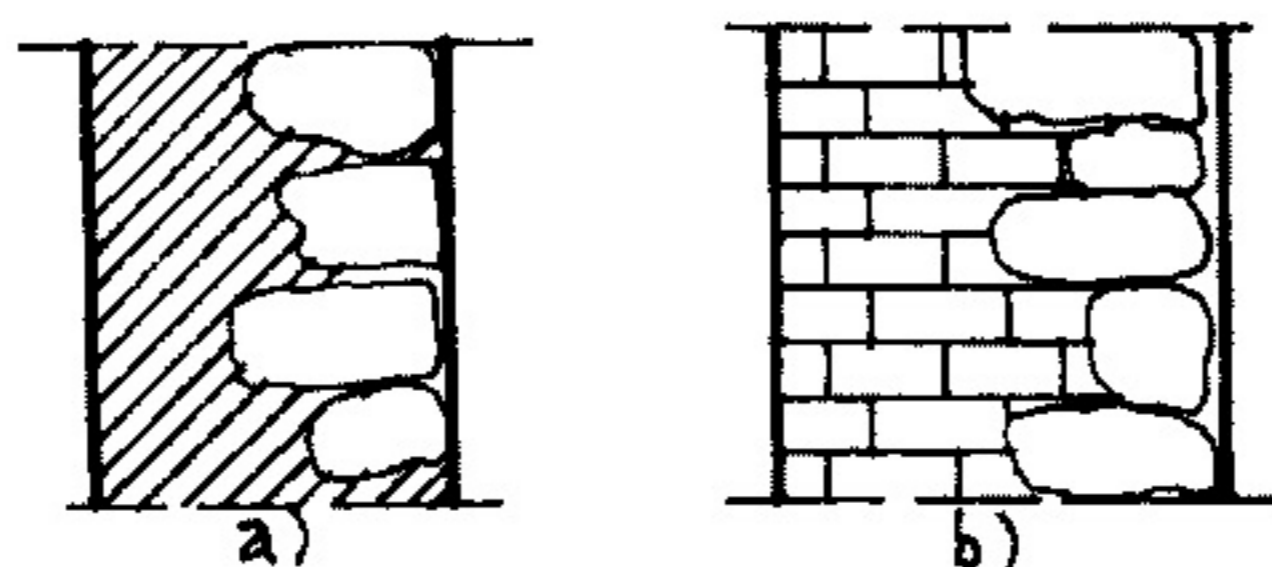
Zidărie mixtă; a - piatră și beton; b - piatră și cărămidă
